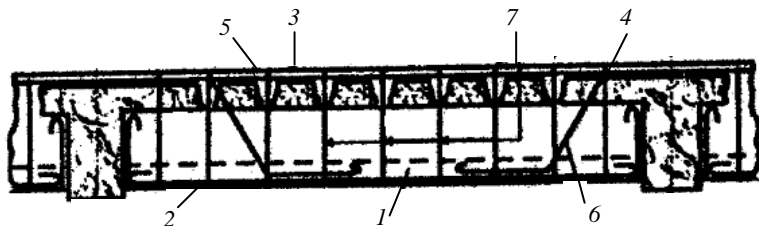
Усиление монолитной балки железобетонной обоймой:
